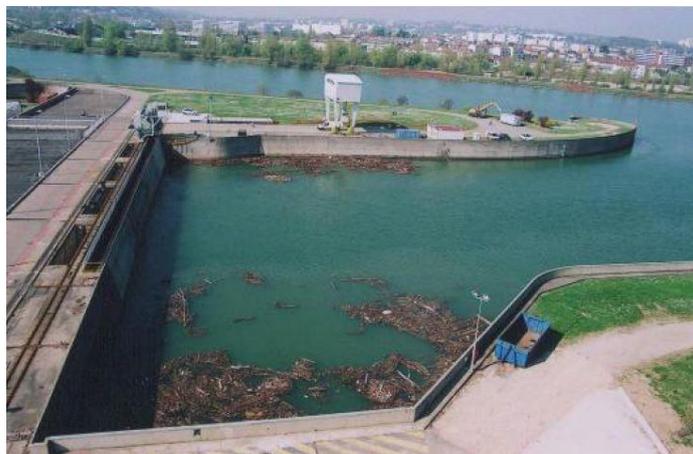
Canal d'amenée situé à Pierre Bénite, (CNR, 2009)
